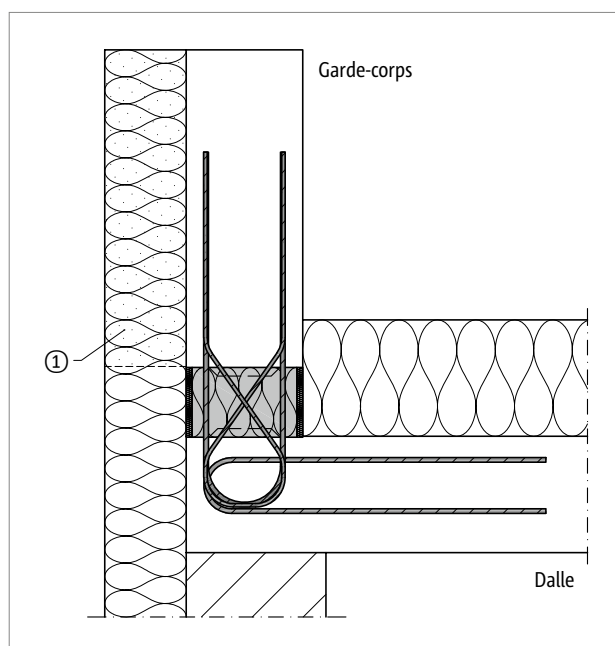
Schöck Isokorb® T Type A : Raccordement sur garde-corps (Type A-MM2-VV1)
